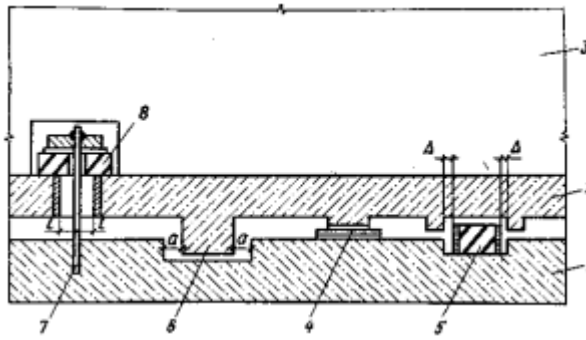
Схема элементов сейсмоизолирующего скользящего пояса 1 – верхняя обвязка фундаментов (стен подвала или технического подполья); 2 – ростверк; 3 – надземные конструкции здания; 4 – скользящая опора; 5 – упругий ограничитель горизонтальных перемещений (демпфер); 6 – жесткий ограничитель горизонтальных перемещений (упор); 7 – ограничитель вертикальных перемещений (вертикальная связь); 8 – вертикальный амортизатор.
